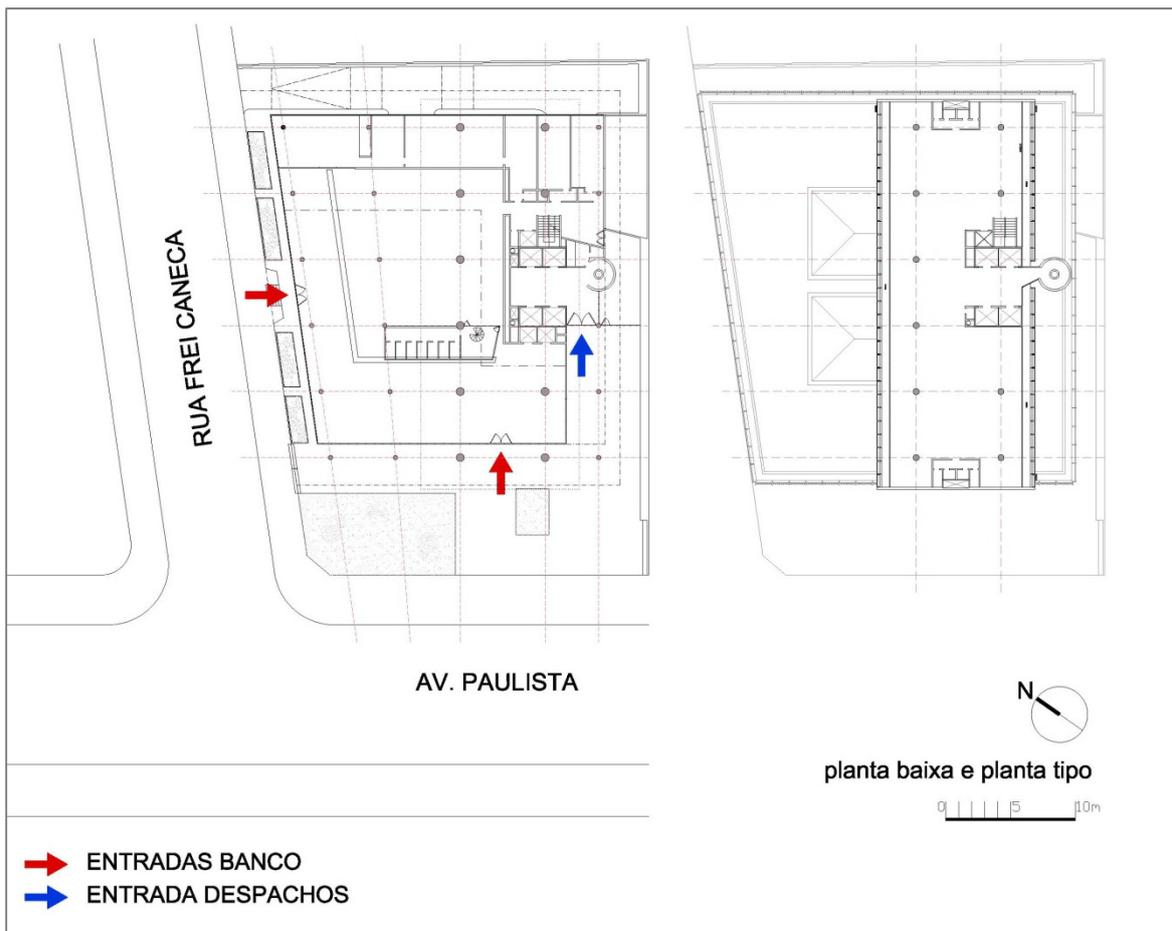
Planta baixa e tipo, do edifício Banco Sul-Americano do Brasil.
